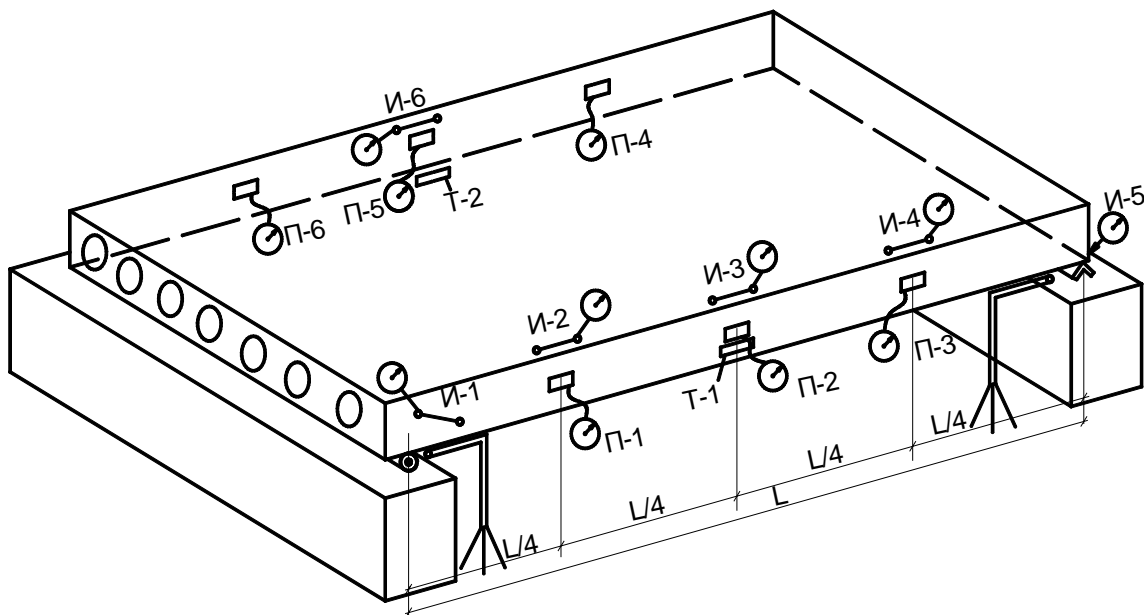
Схема размещения датчиков показаний при испытании предварительно напряженных плит перекрытия
